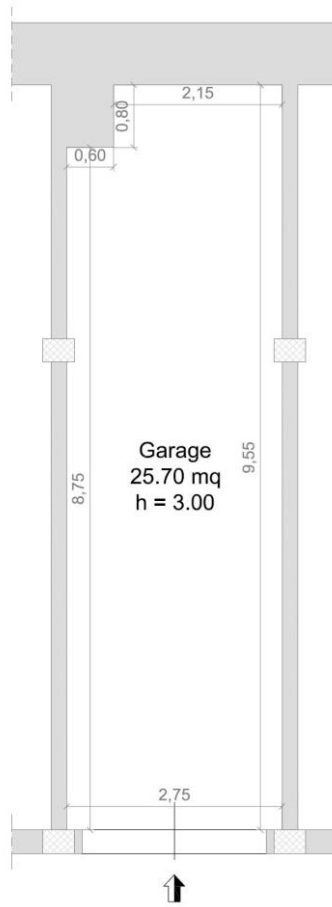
Planimetria Catastale Foglio 29, p.lla 1255, sub 31.
